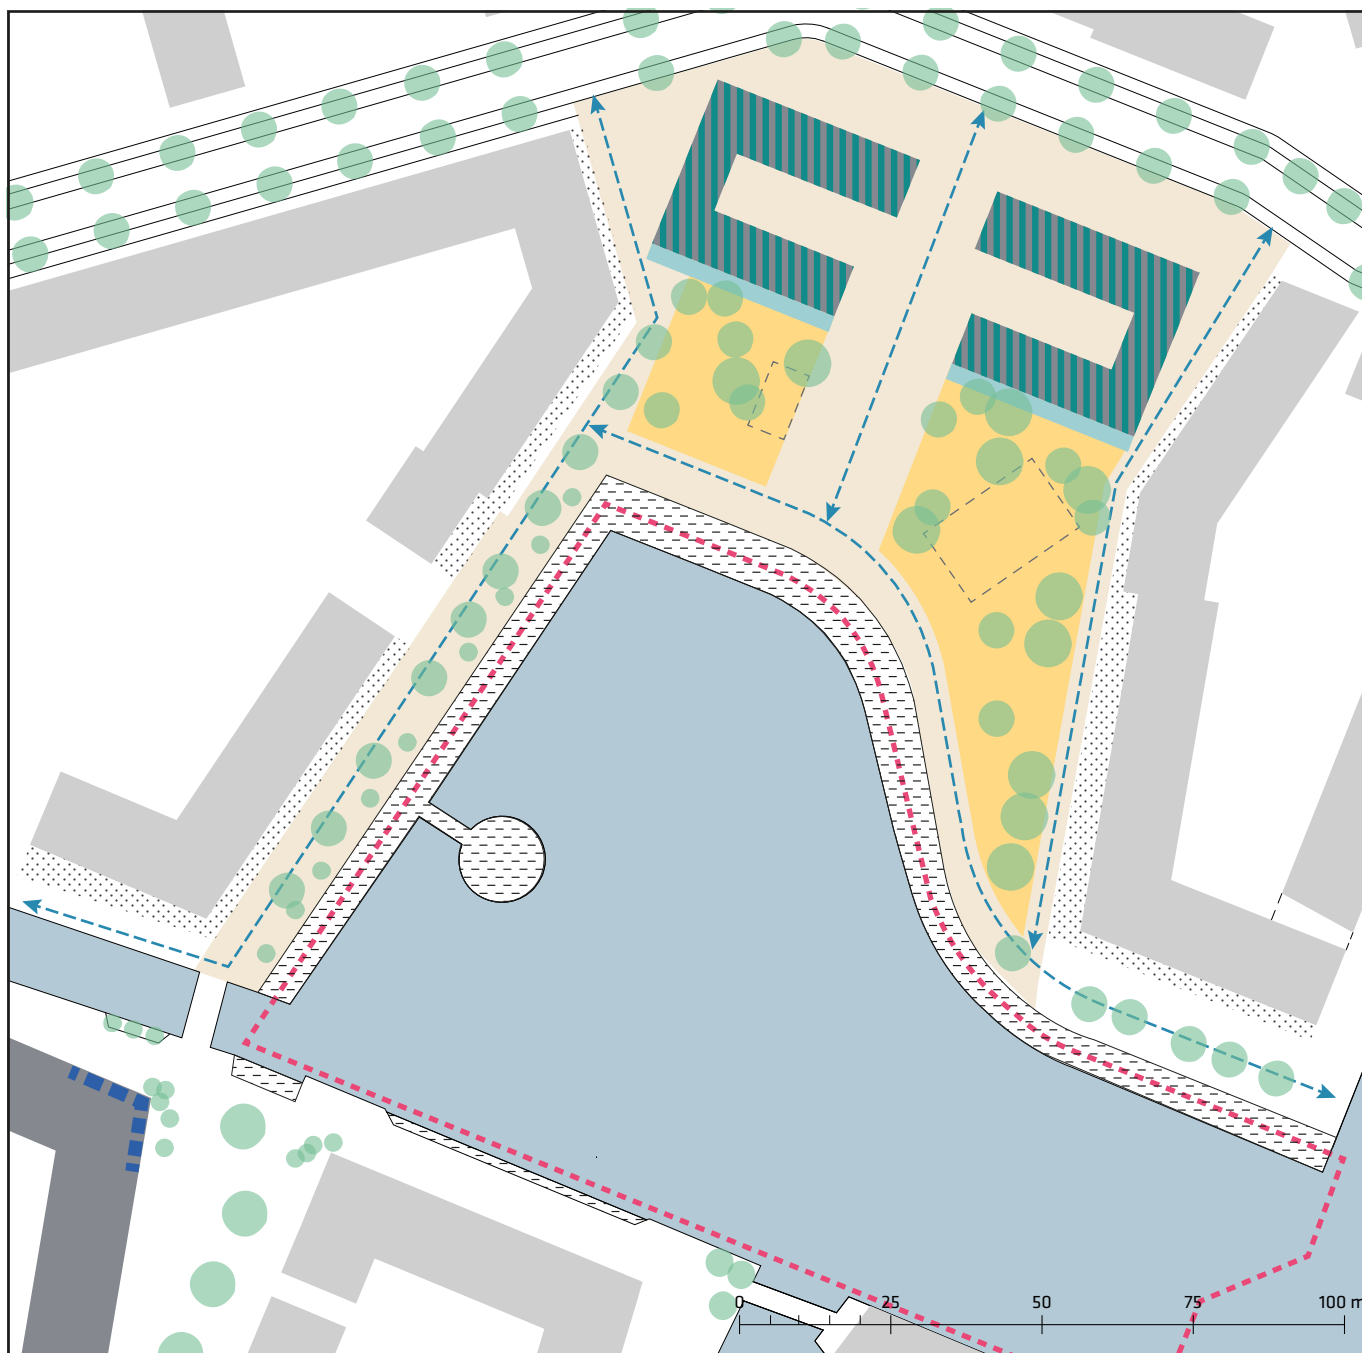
Illustration B viser den ændrede bebyggelsesplan med den ønskede udvidelse af stueetagen vist med lys skravering.
